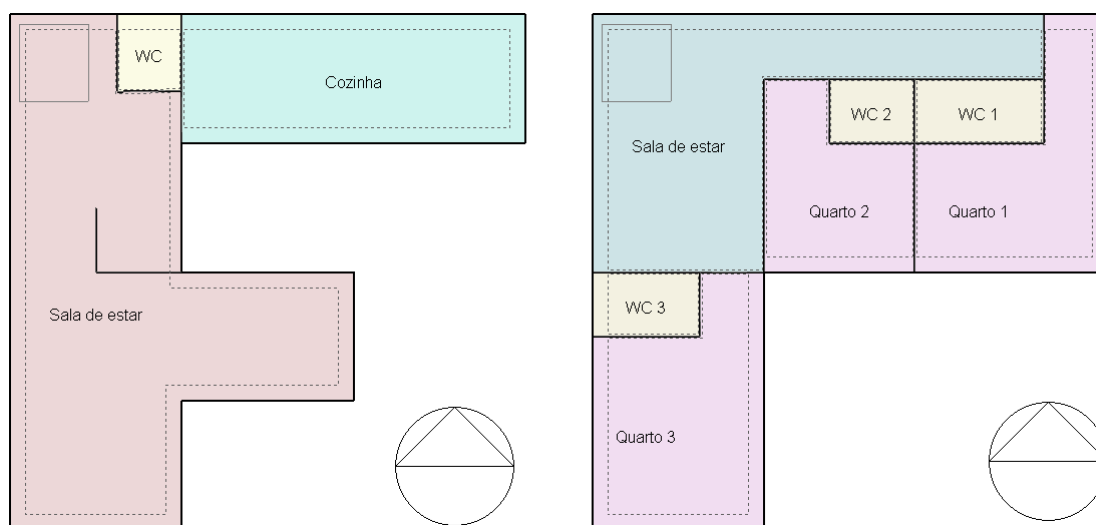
Planta do piso 0 (Esq.) e planta do piso 1 (Dir.) da moradia
